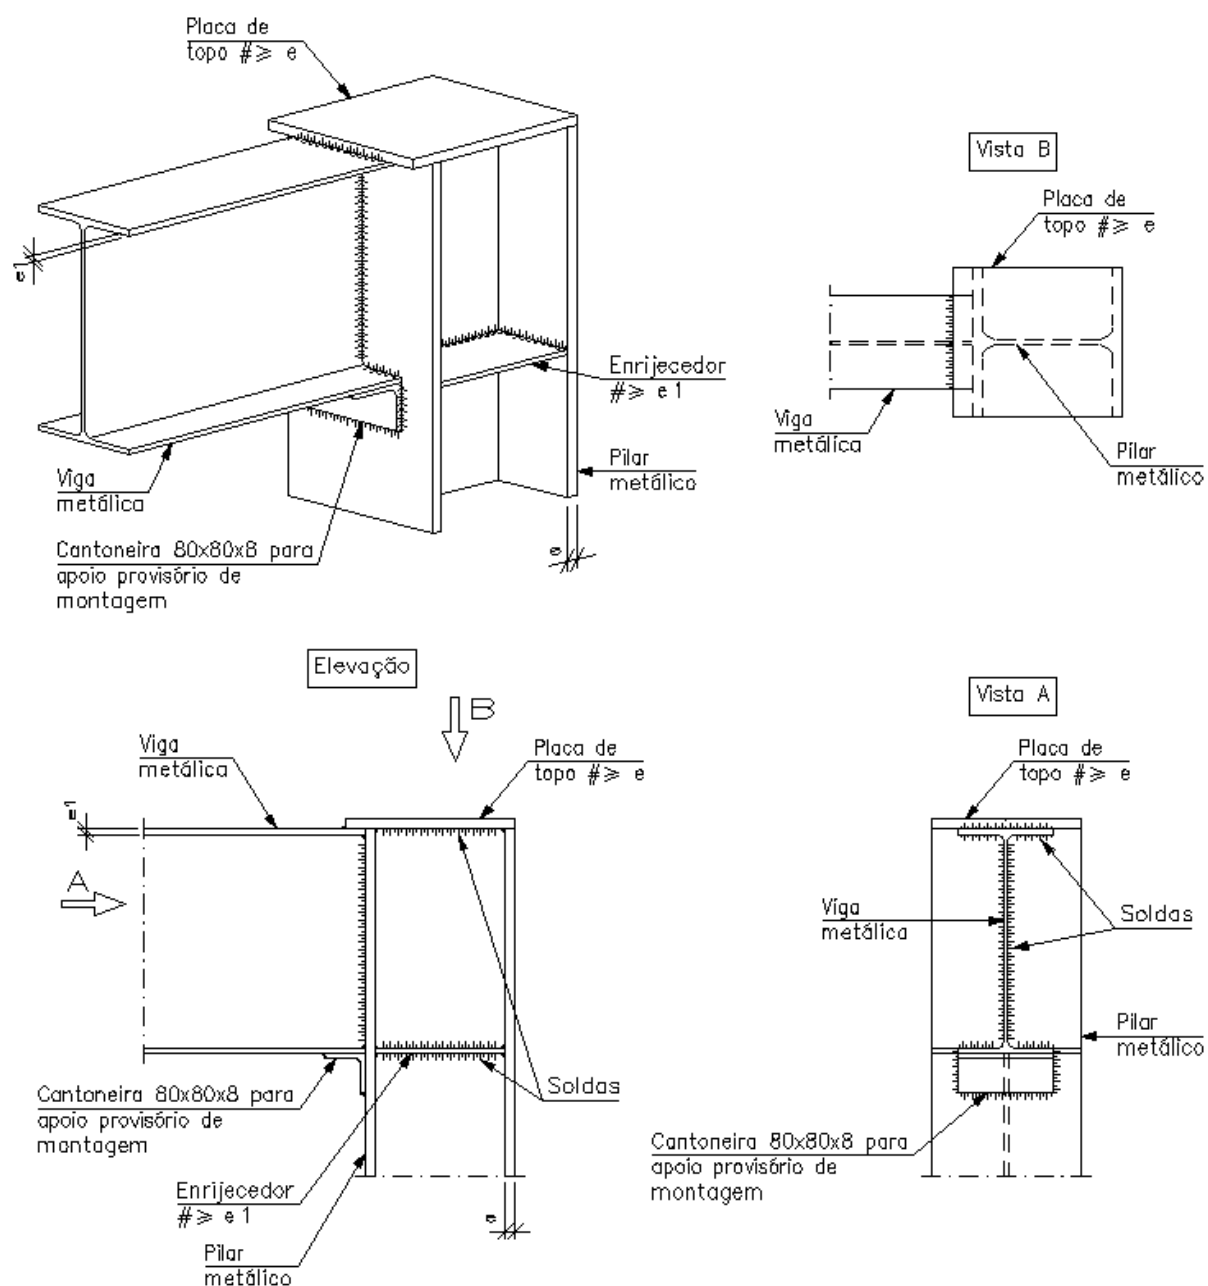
Ligação articulada de vãos adjacentes com pilar da última planta
